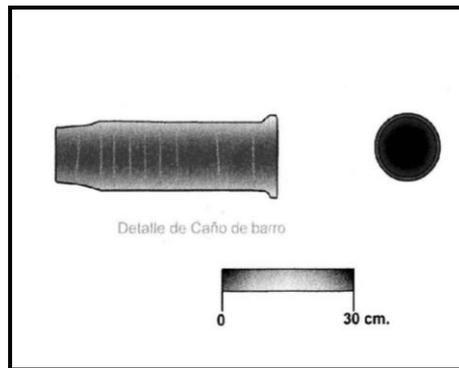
Detalle del caño de barro y su protección. J. Cáceres.
